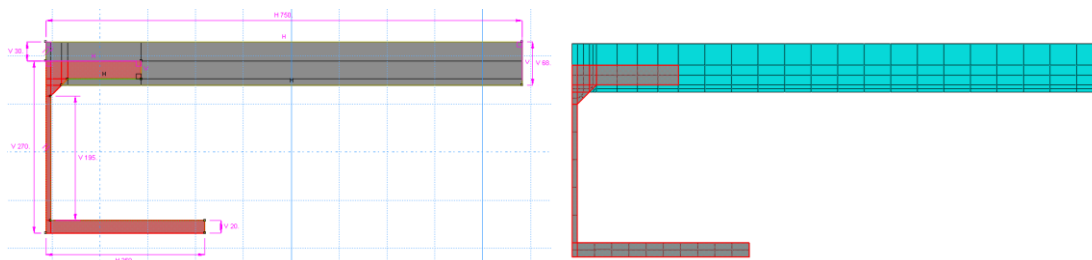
Sketch da viga mista IFB do pavimento com 30cm de espessura e respetiva malha de elementos finitos.
